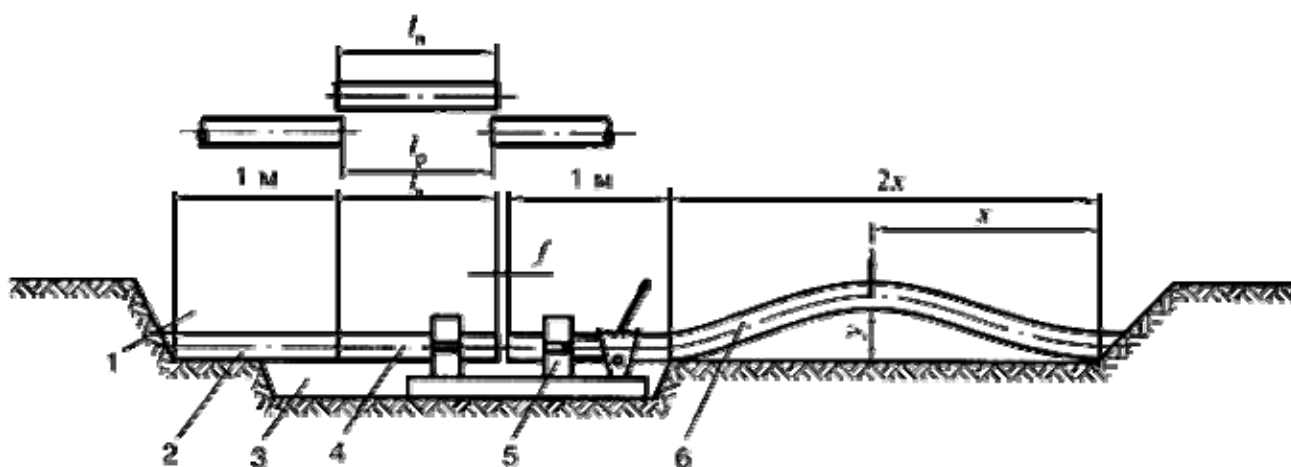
Схема освобождения полиэтиленового трубопровода от грунтовой присыпки по длине и вварки трубной вставки встык
